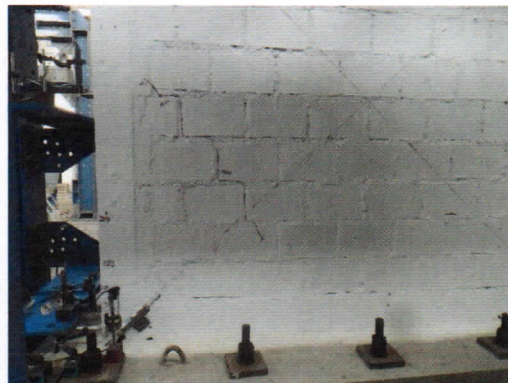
Formación de las primeras grietas en la cara norte del talón de la columna Este para una distorsión 1/1500.
